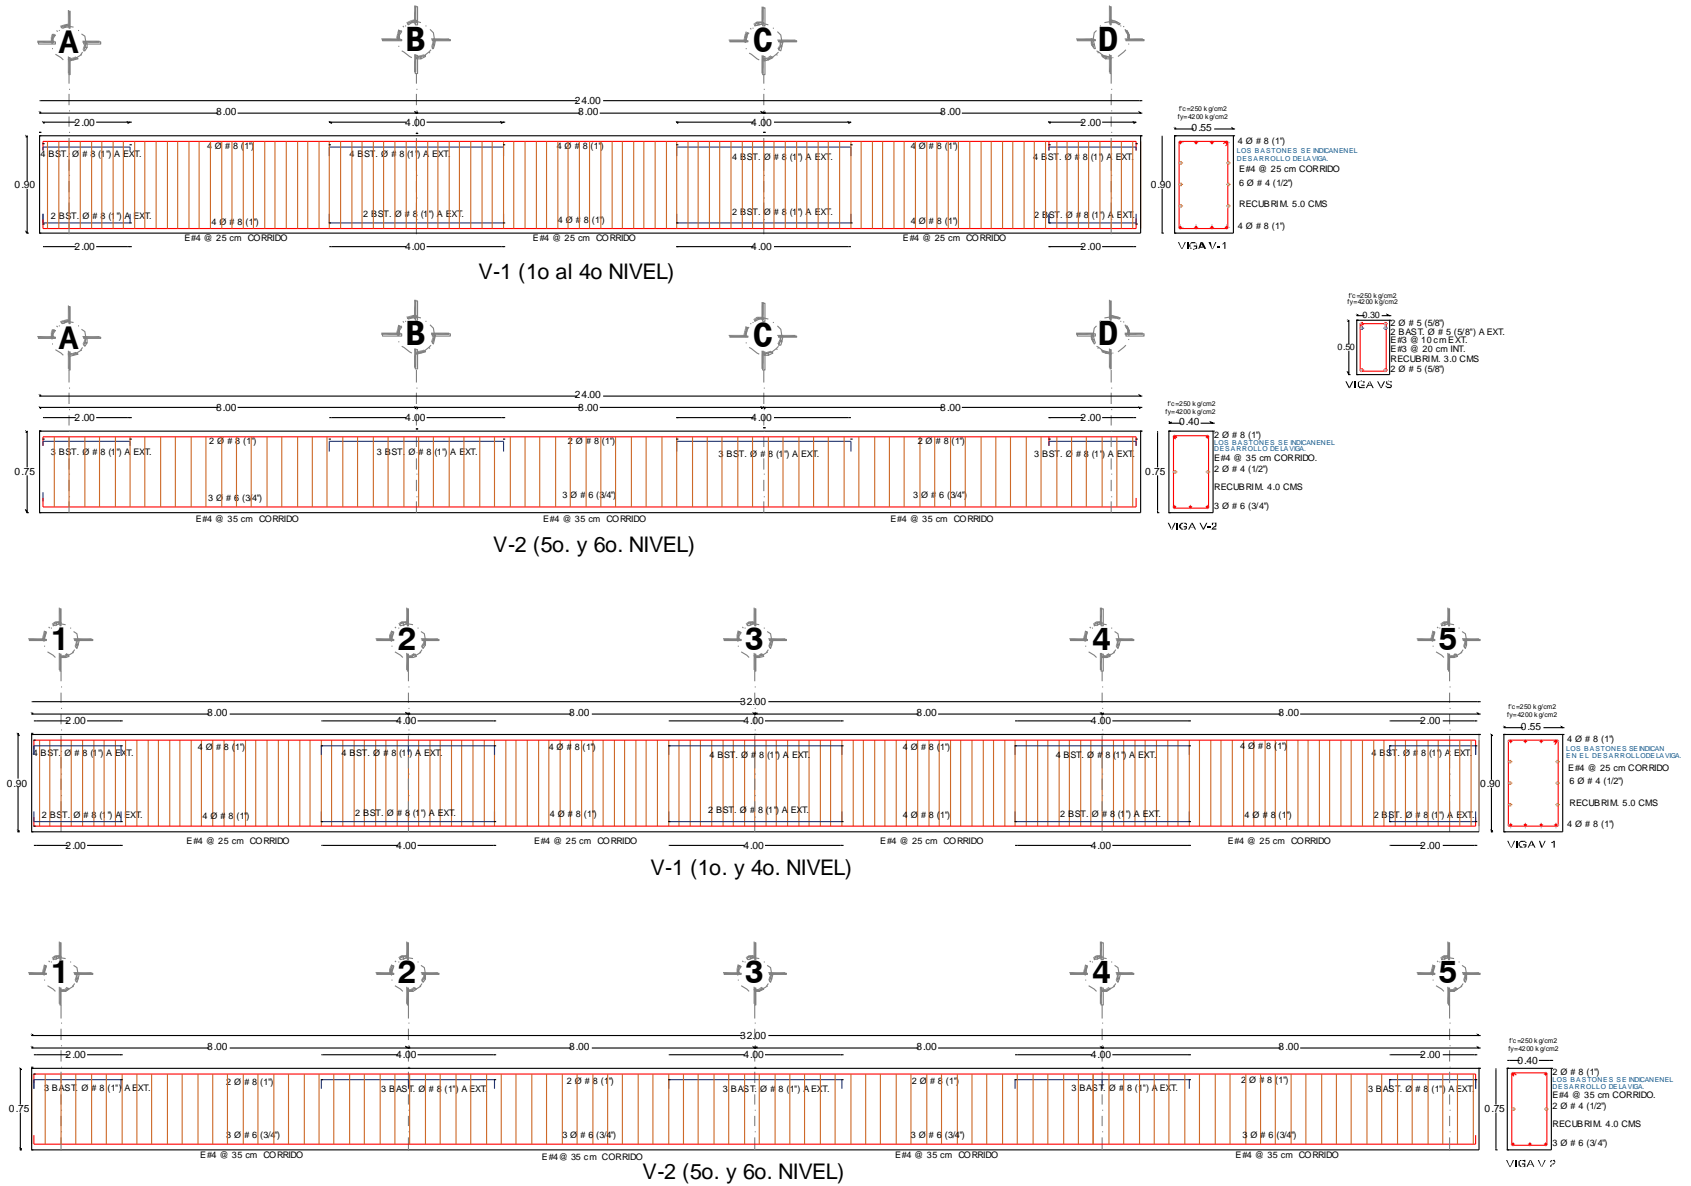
Detallado de armado de vigas de edificio de 6 niveles con base a la hipótesis de las NTCC-04.
